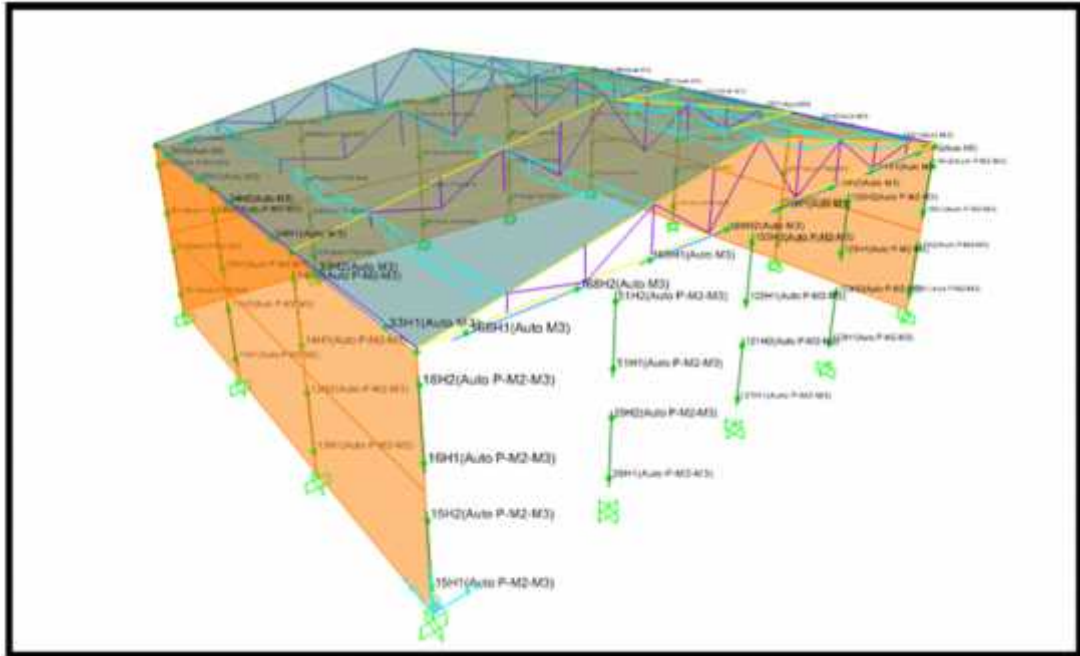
Asignación de rotulas plásticas en vigas y columnas
